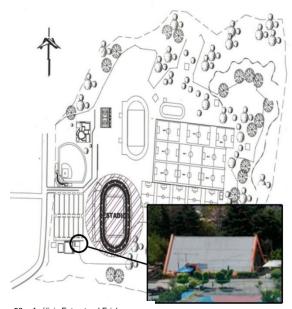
Análisis Estructural Erick Bernabé Barrondo. Fuente: Elaboración Propia
